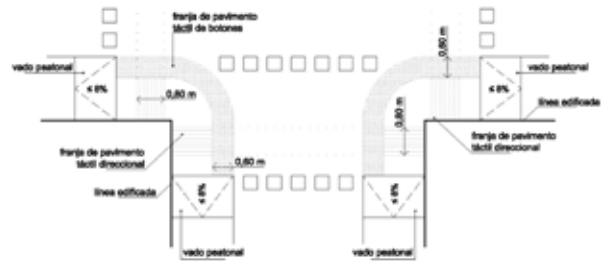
Franja de pavimento táctil indicador direccional que da continuidad a la línea edificada.
